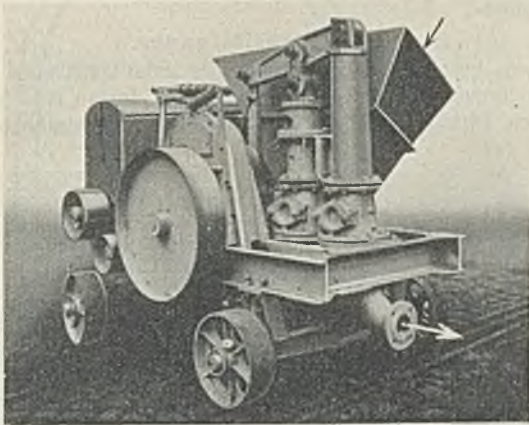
Betonpumpe System Giese-Hell (Torkret G. m. b. H.).
